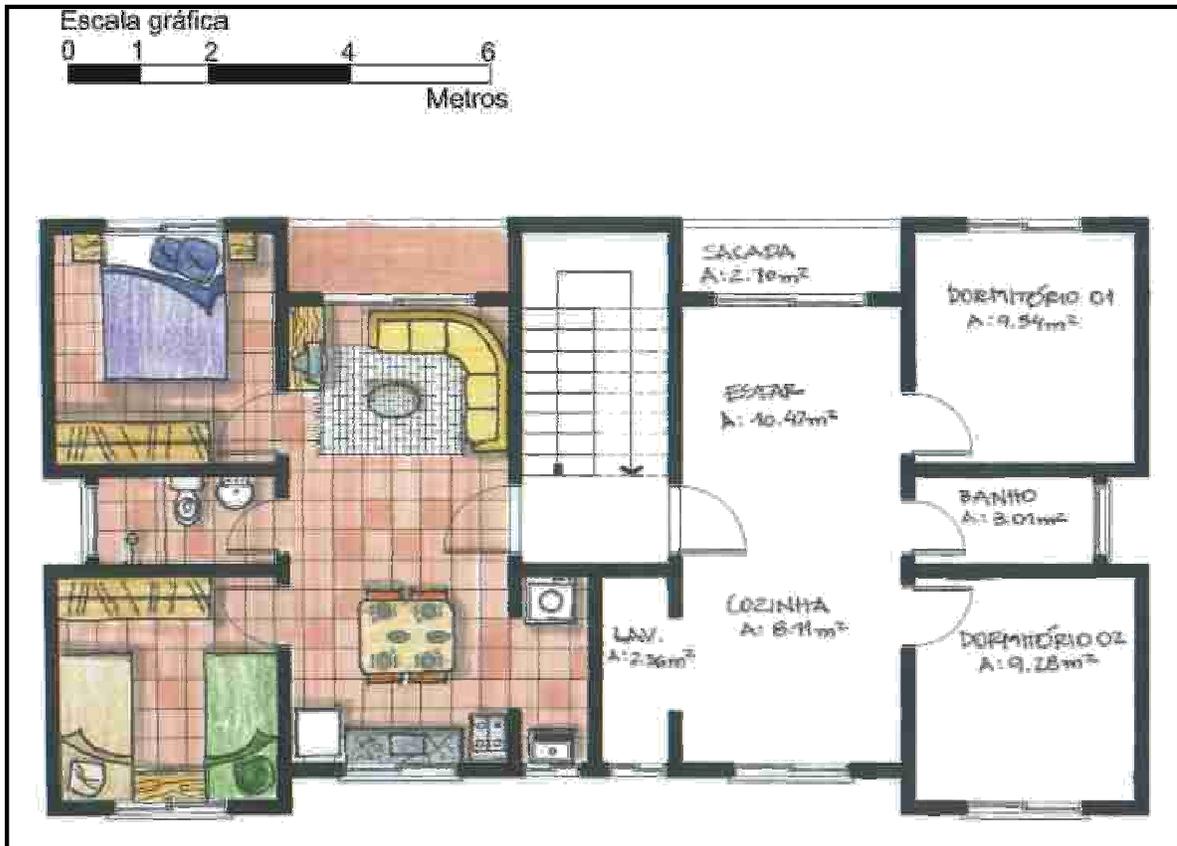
1ª proposta de planta baixa para a nova tipologia.
